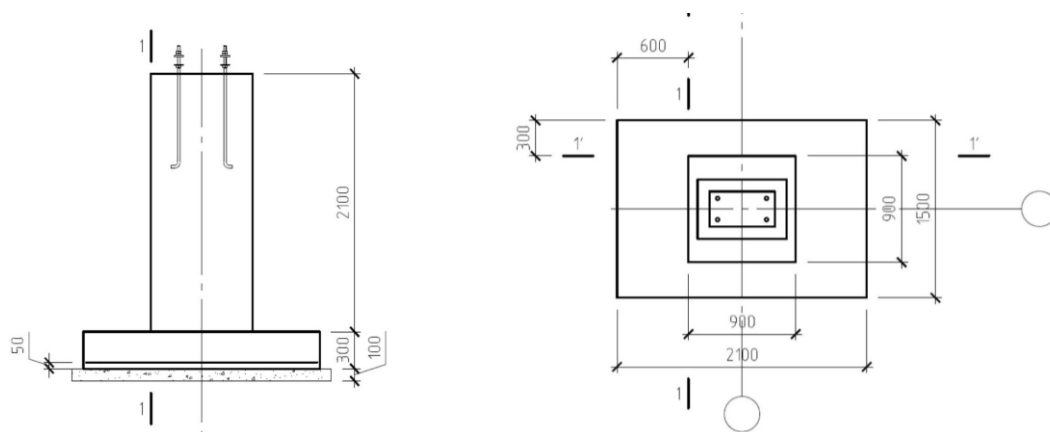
Схема розрахунку арматури плитної частини фундаменту
